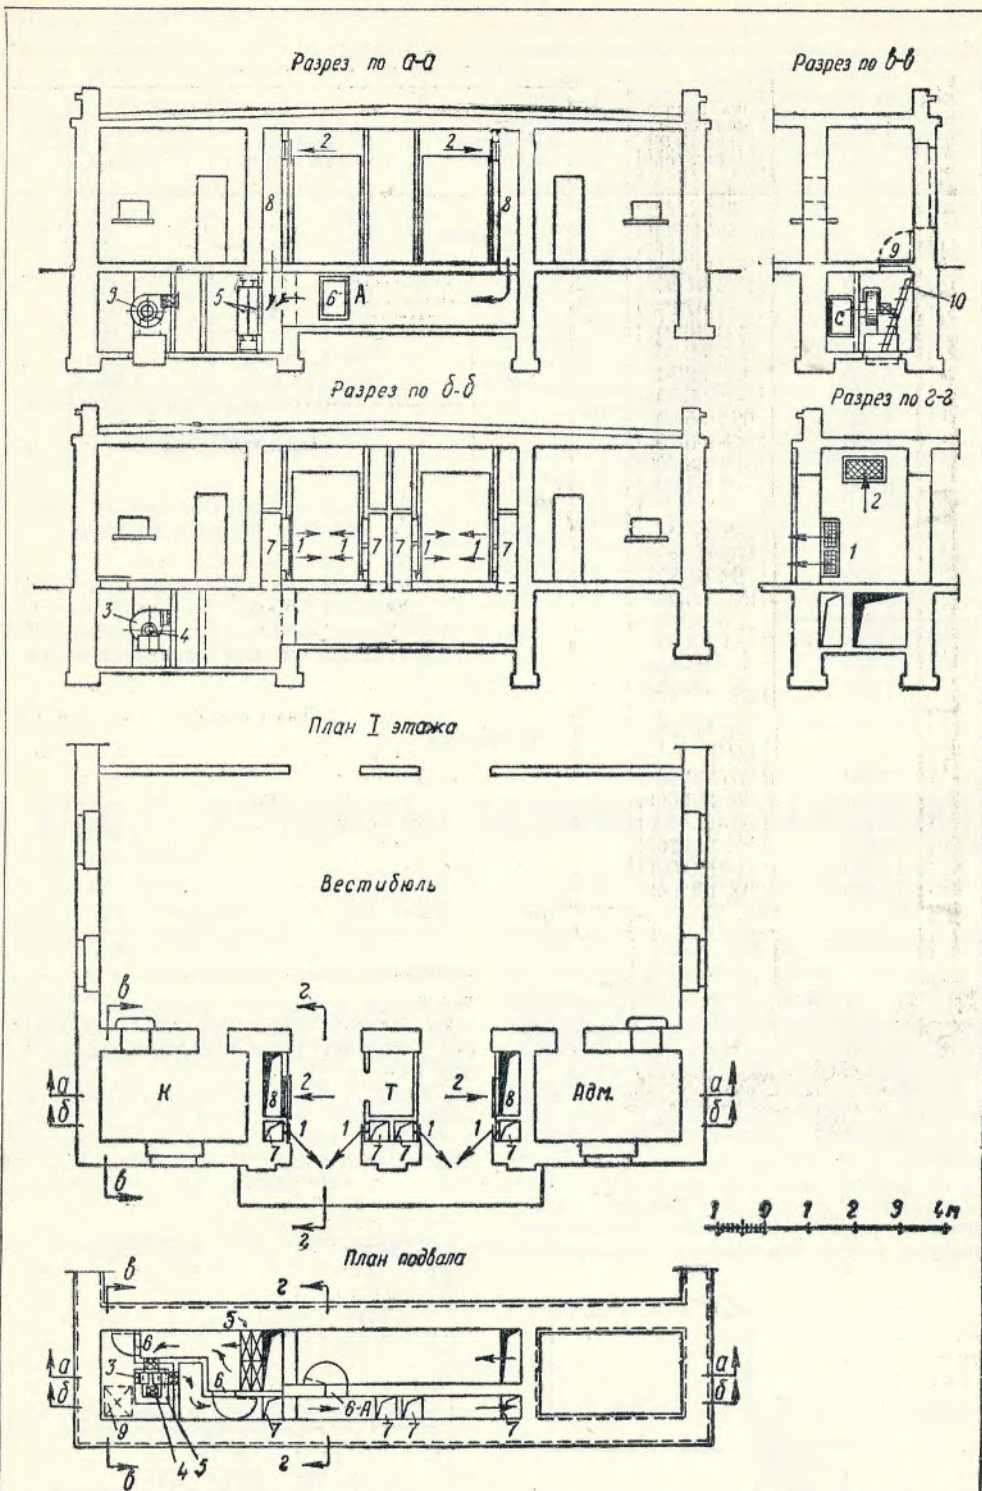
Пример решения воздушно-тепловой завесы с центробежным вентилятором ЭВР № 4
